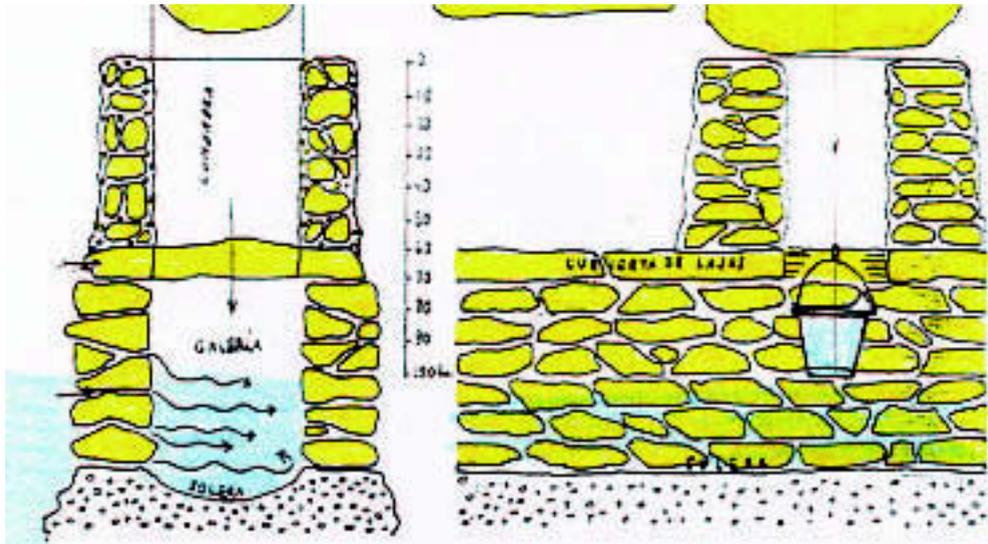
Sección del Caño Viejo. El agua se filtra a través del muro de piedra en seco hacia el interior de la galería.
